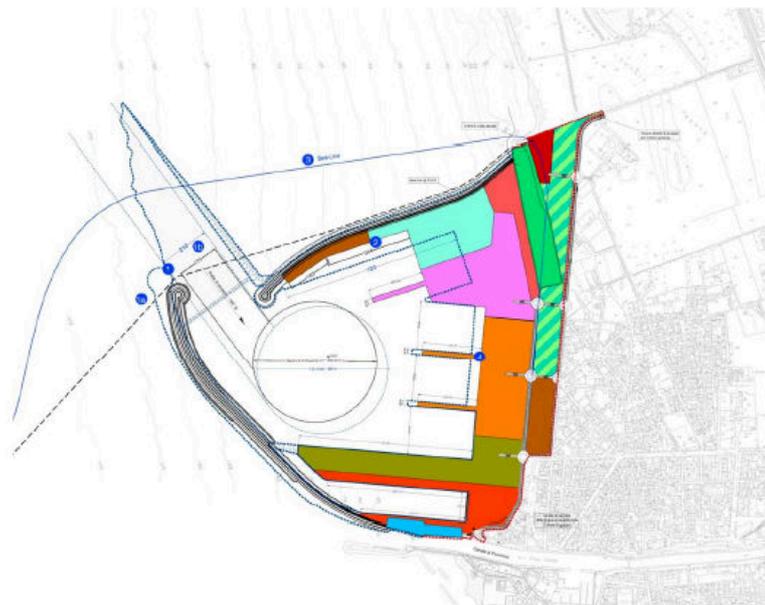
Planimetria con evidenziazione della proposta di A.T.F. confrontata con il P.R.P. vigente
